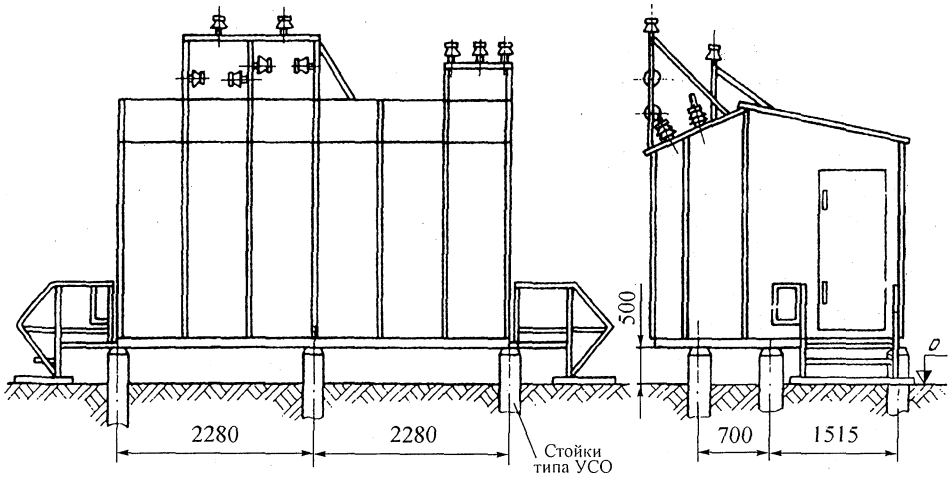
Установка КРУН на заглубленном фундаменте
